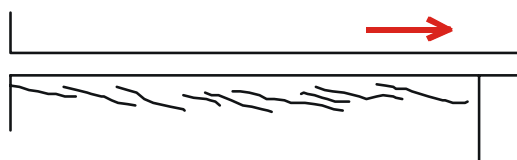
fissura horizontal com componentes inclinados (escamas) por movimentação térmica da laje (VERÇOZA, 1991)
